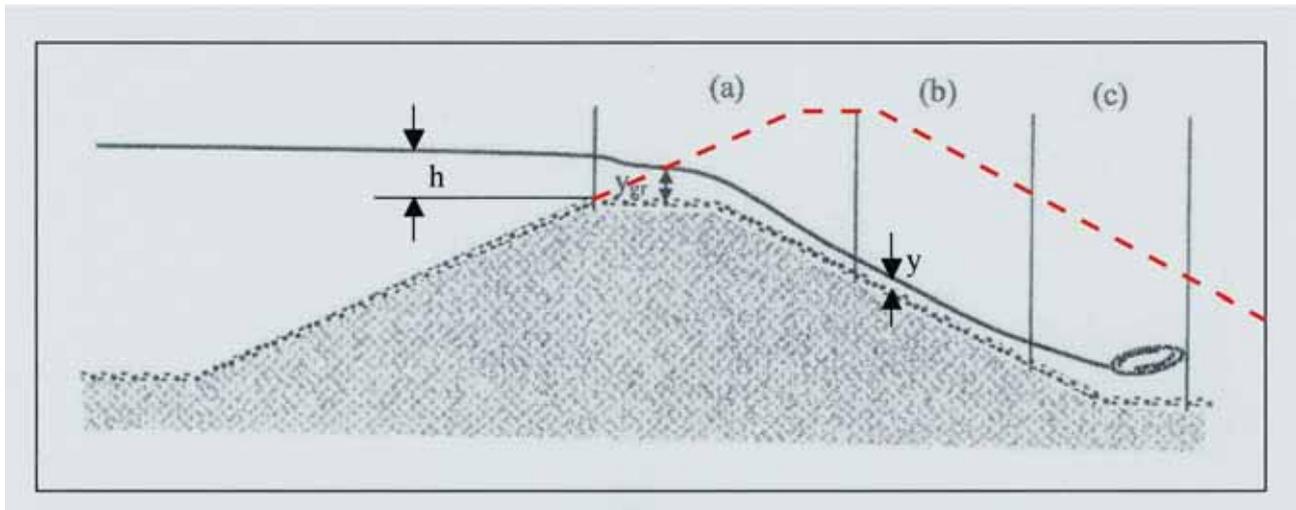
Definitionsskizze zur Ermittlung der Wasserspiegellage im Staubecken
